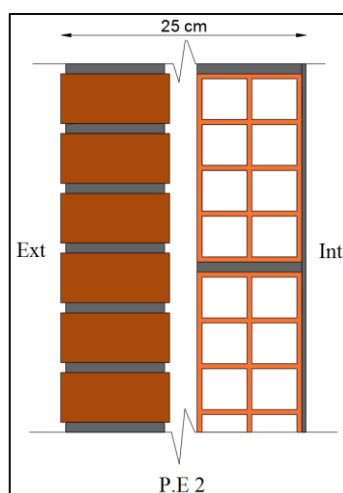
Corte da Parede Exterior 2 (P.E 2)
